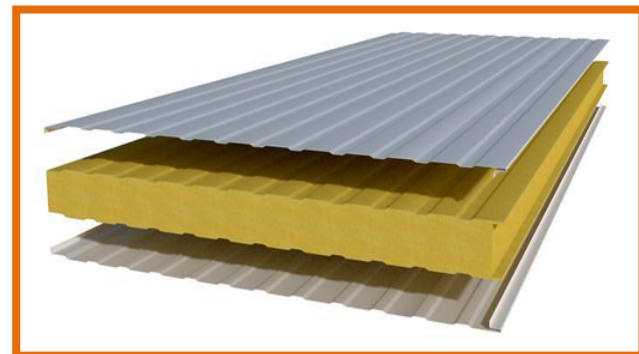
Plancher sandwich (<http://etelta.com/paneles-sandwich-para-cubiertas-y-fachadas.html>)
